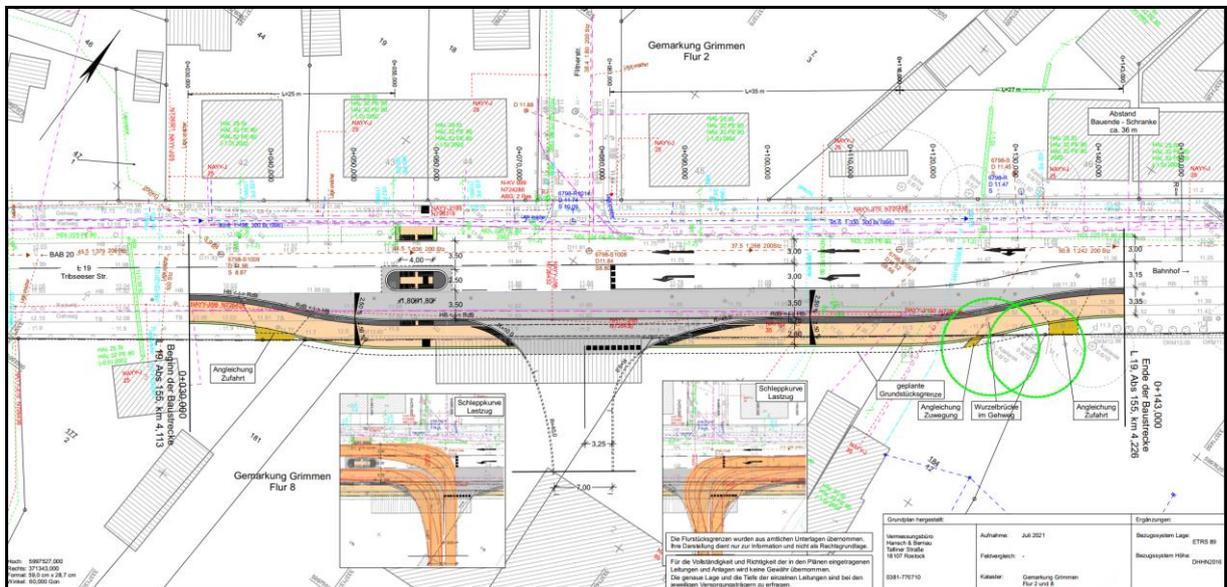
Lageplan der Verkehrsplanung für die Fahrbahnaufweitung und Zufahrt zum Plangebiet; VEAPLAN Verkehrsplanung, Charles-Darwin-Ring 4, 18059 Rostock
